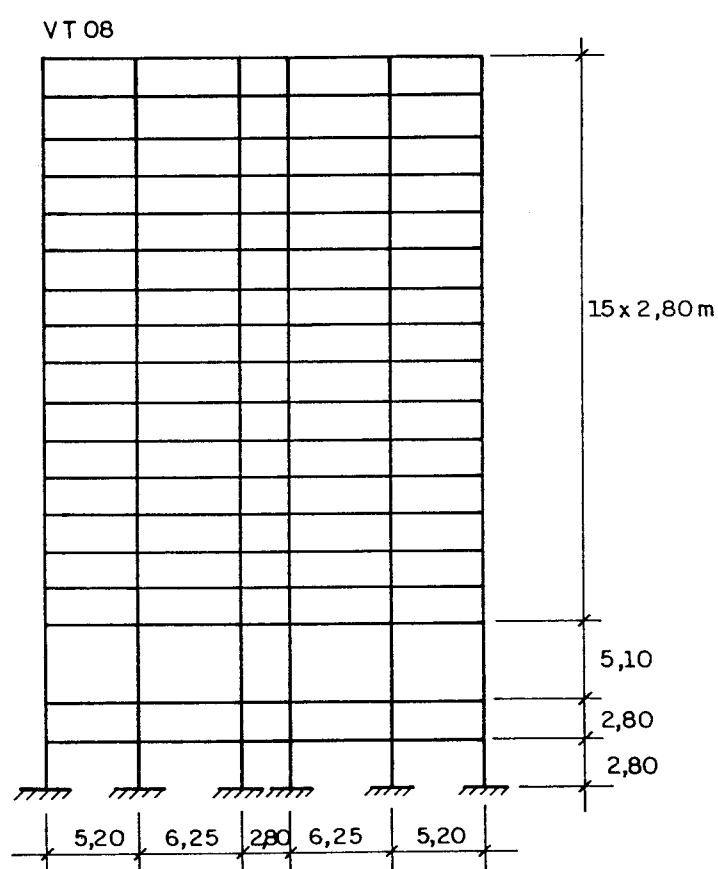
Pórtico plano com a viga VT08 a partir do 4.º pavimento
